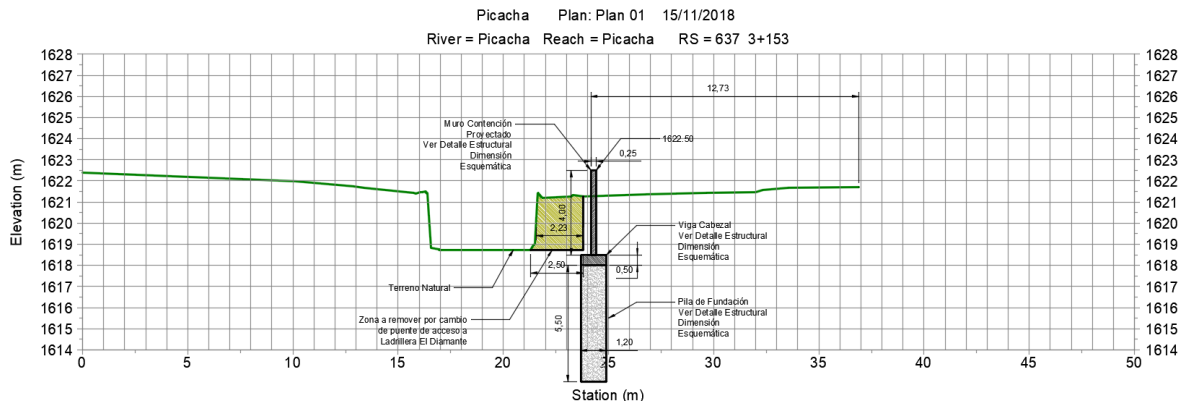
Sección transversal típica, cruce a Ladrillera El Diamante.
